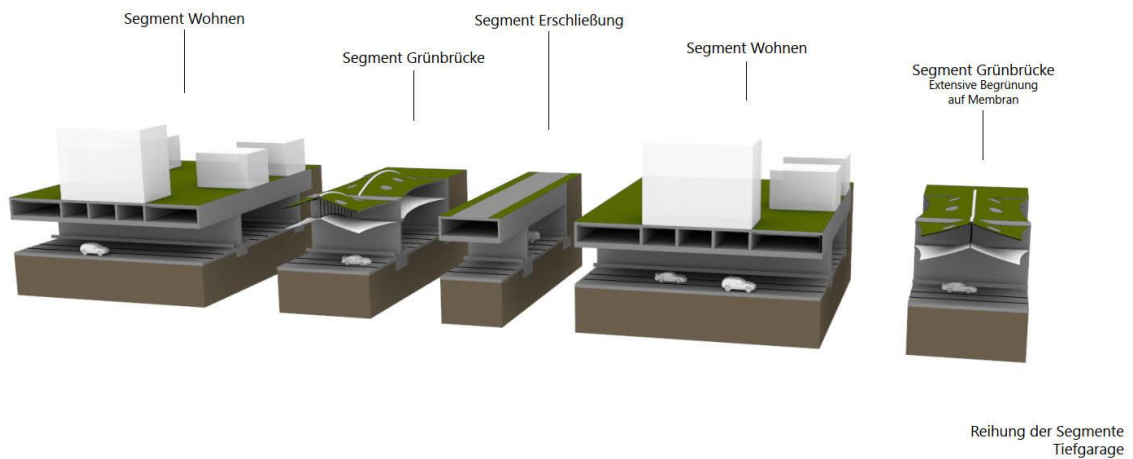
Explosionszeichnung der Tragwerksmodule
